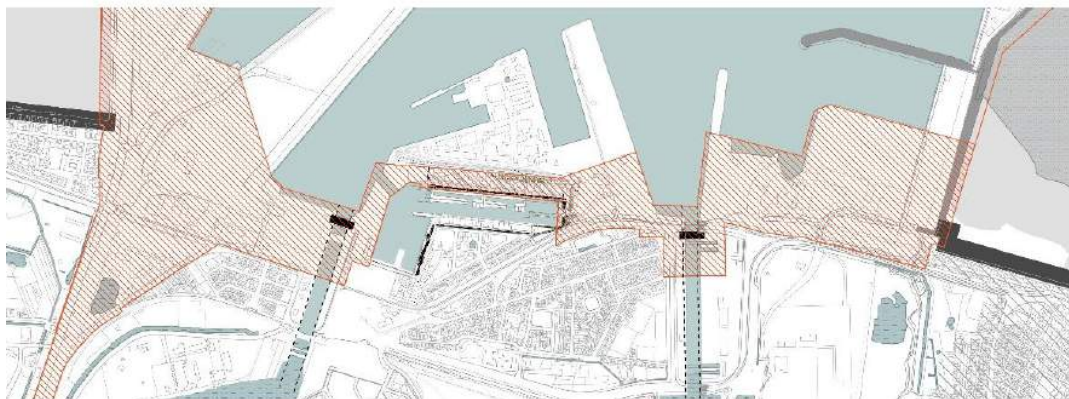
Alternatief voor de haven met een sluis en stormvloedkering
